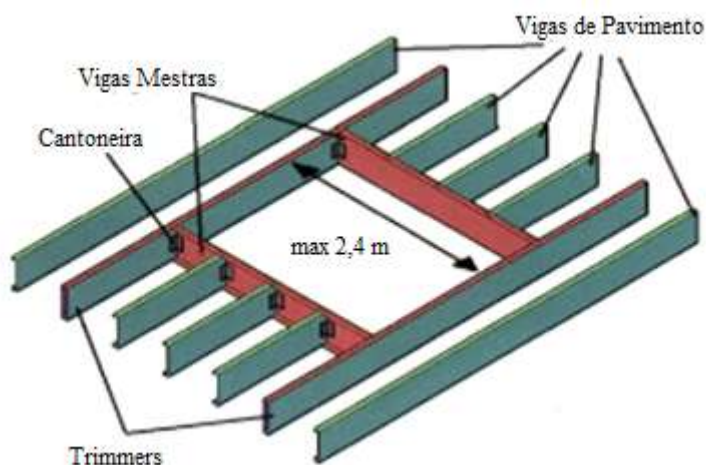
5 - Abertura no pavimento. (Silvestre et al, 2013)
